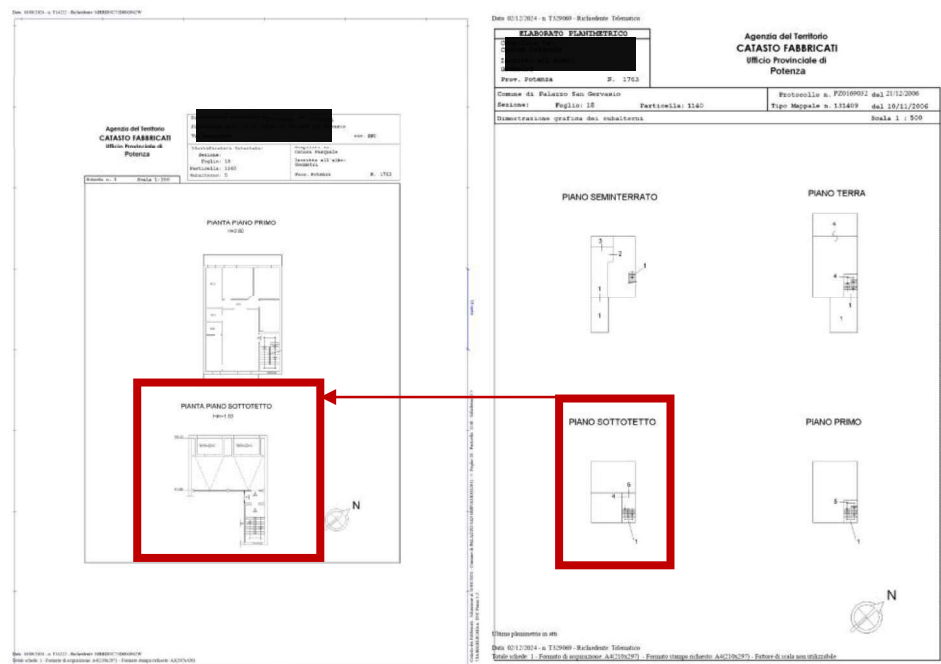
Planimetria Catastale ed Elab. Planimetrico Lotto LU – Piano Sottotetto (ALL. 06).
